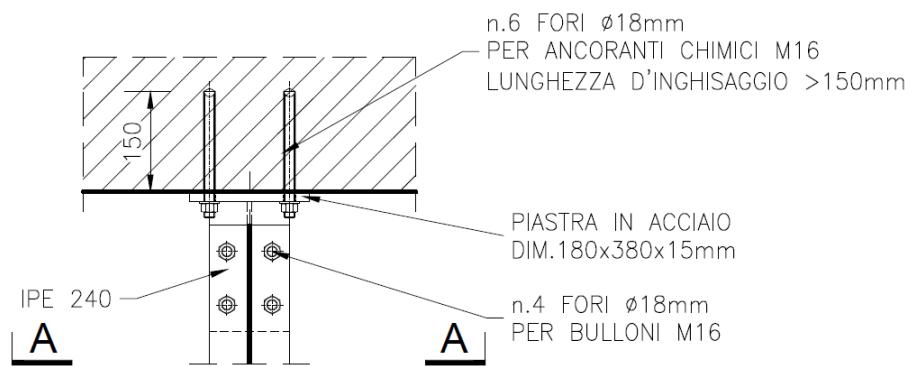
Pianta della connessione IPE240 - "Particolare 3"
